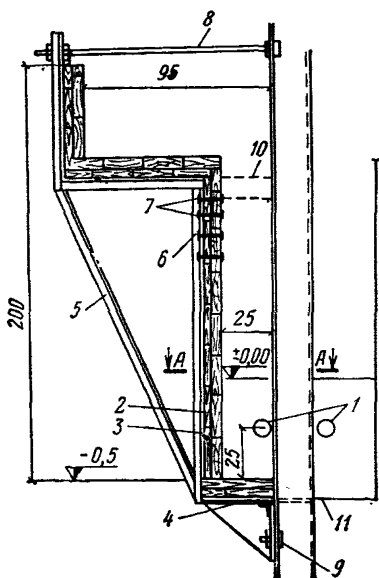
Схема опалубочного щита водонепроницаемой опалубки оголовка
